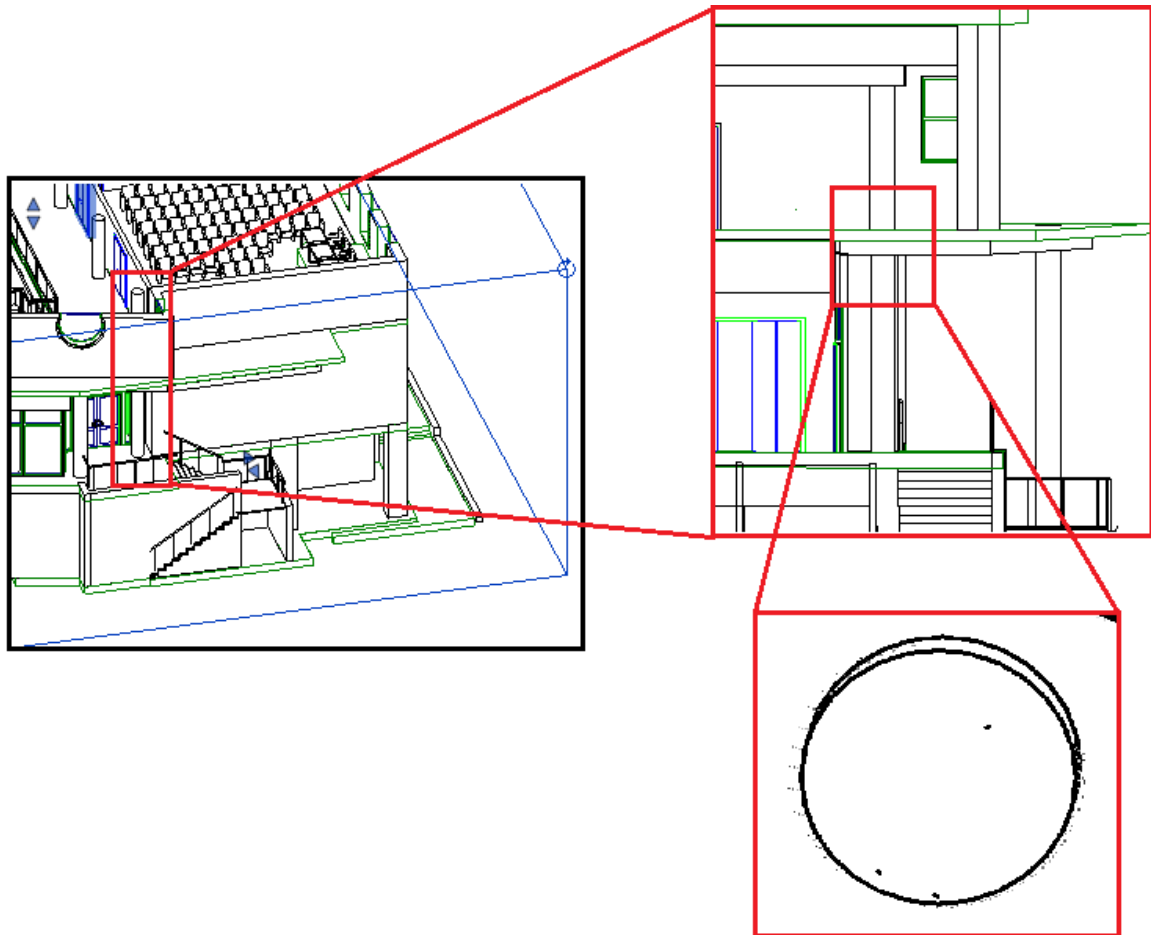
Detalle de la columna “I” (Ilustración 48).
